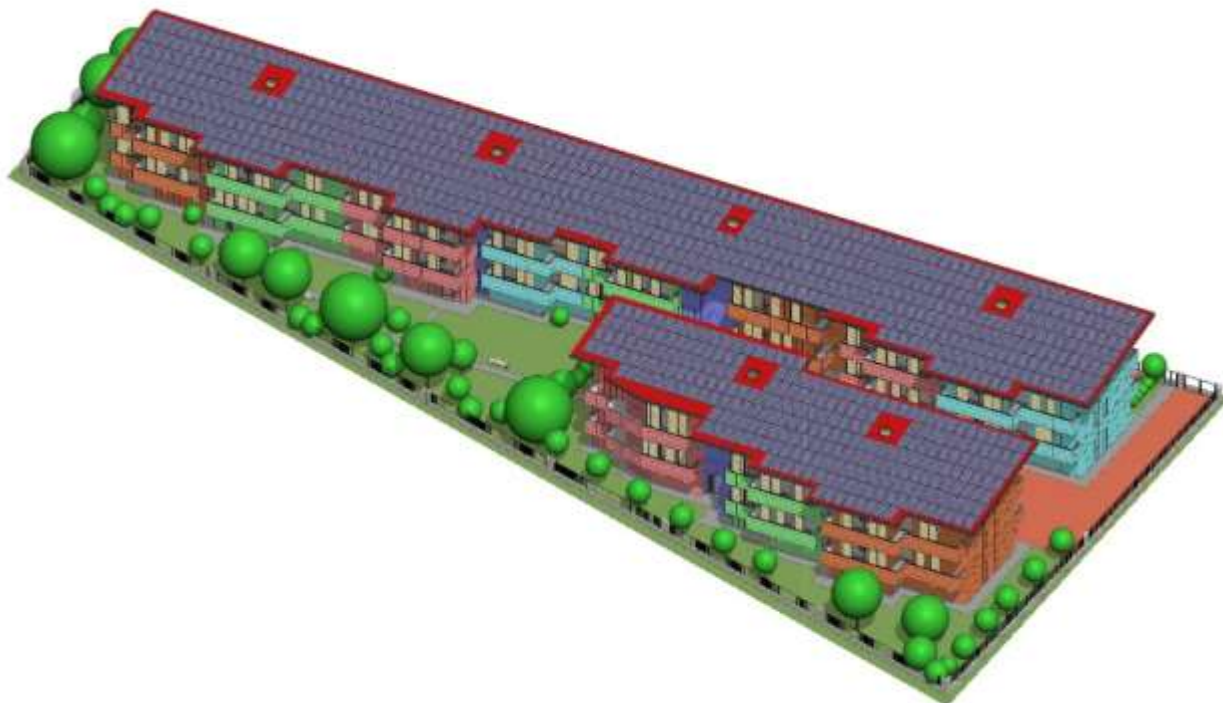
Vista assometria dello stato di progetto. [Fonte: elaborazione dell'autore]
